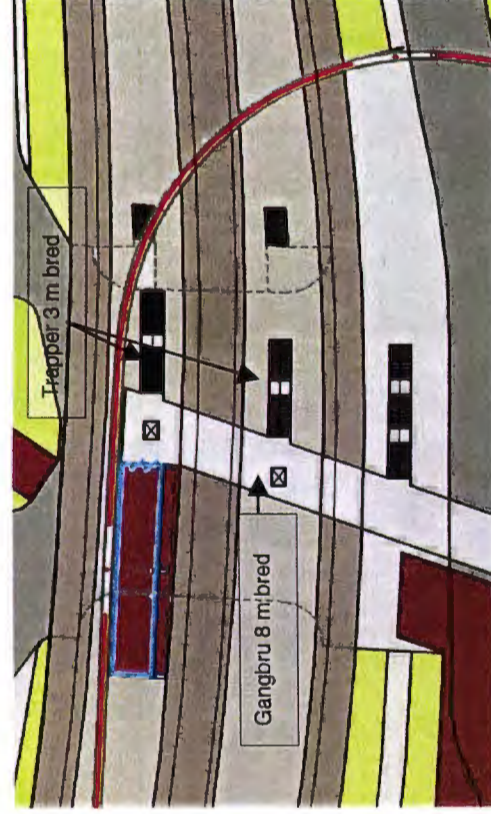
Stasjon Monorail-systemet over nordre jernbanepattform.
